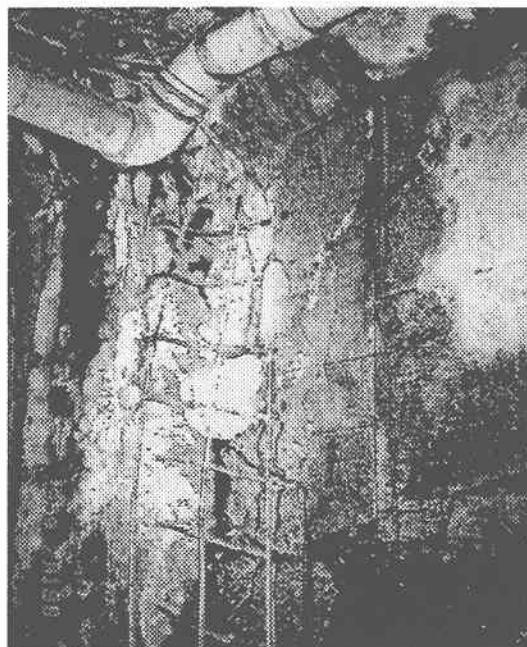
壁のコンクリート剥落、鉄筋露出
